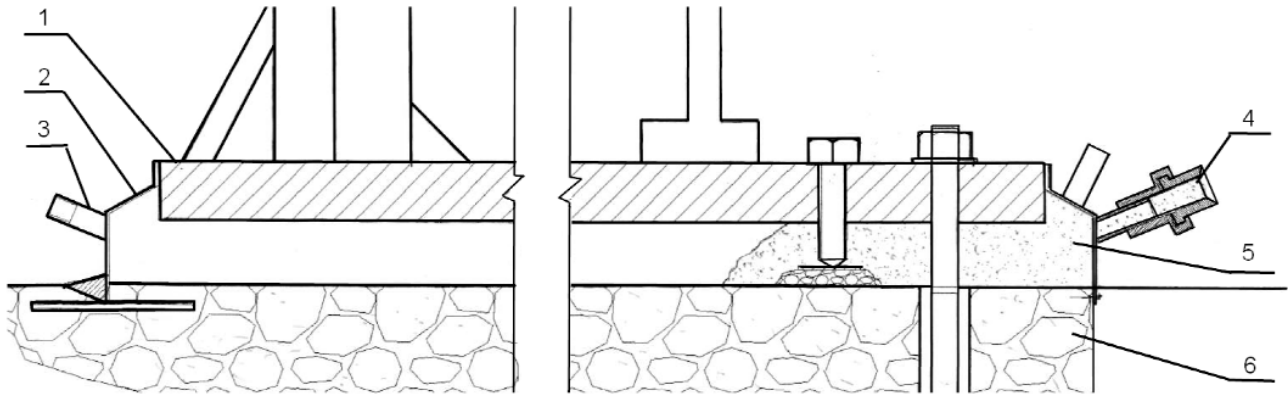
Один из вариантов устройства подливки под оборудование по трубопроводу с герметичной опалубкой: 1 – станина оборудования; 2 – герметичная опалубка; 3 – вентиляционный канал; 4 – трубопровод для подачи (нагнетания) подливки; 5 – смесь; 6 – фундамент
